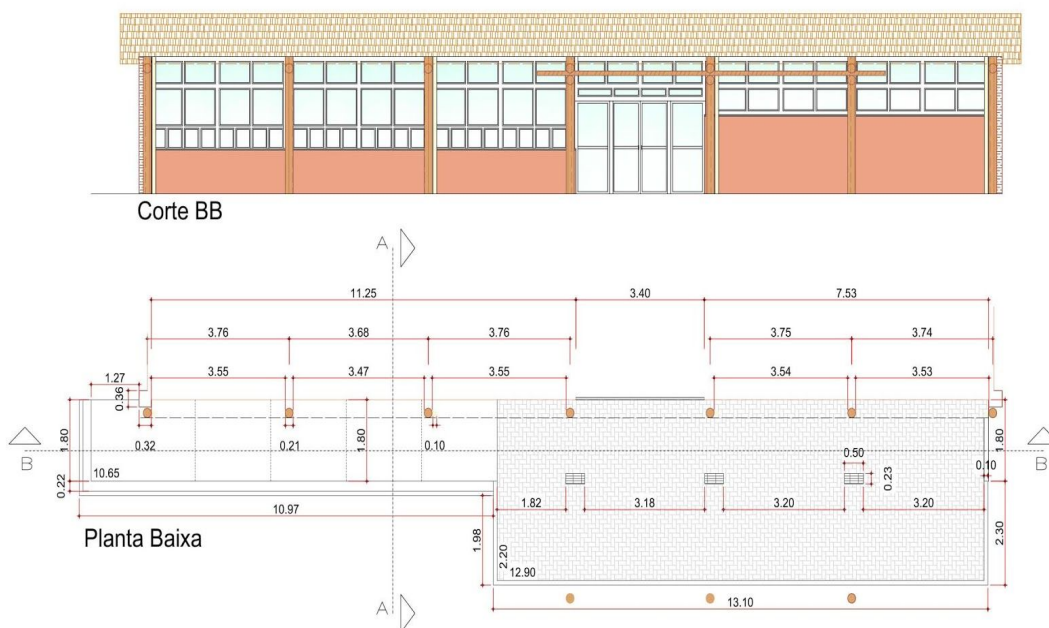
Planta baixa do local. Fonte: elaborado pelos autores.
